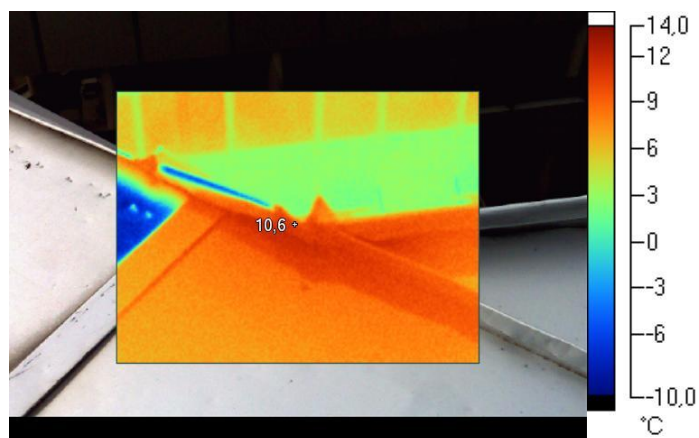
Verbindung Altbau mit dem Neubau auf dem Dach
